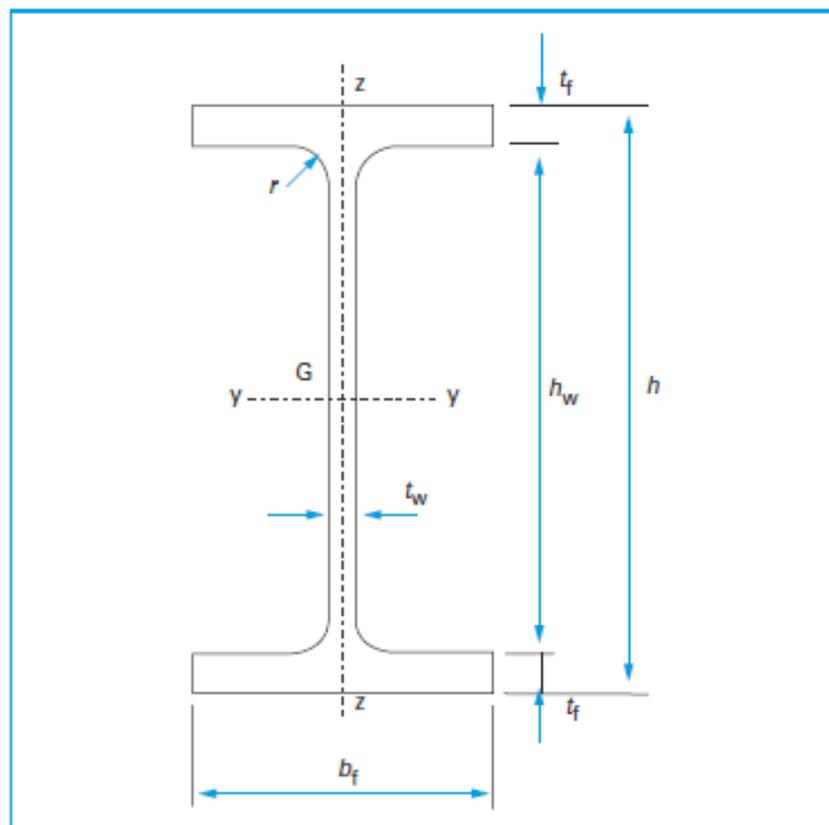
Notations utilisées pour caractériser une section transversale de profilé laminé
